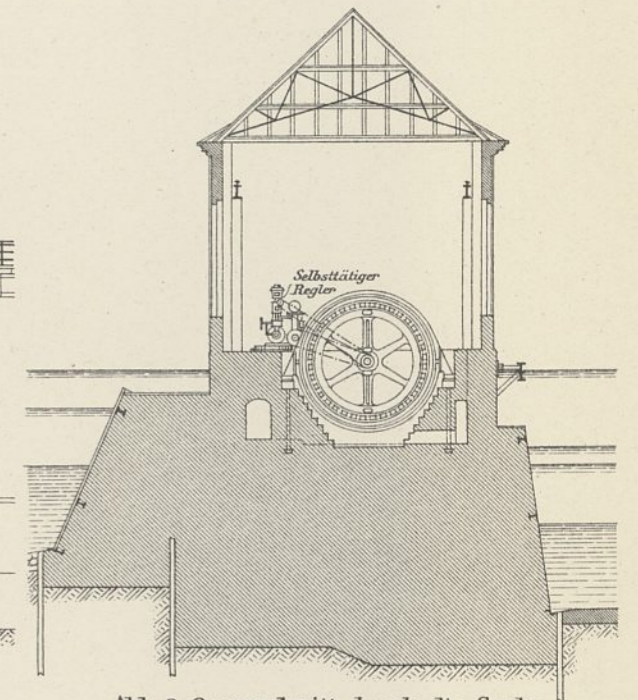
Querschnitt durch die Grube der Drehstromdynamomaschine.
